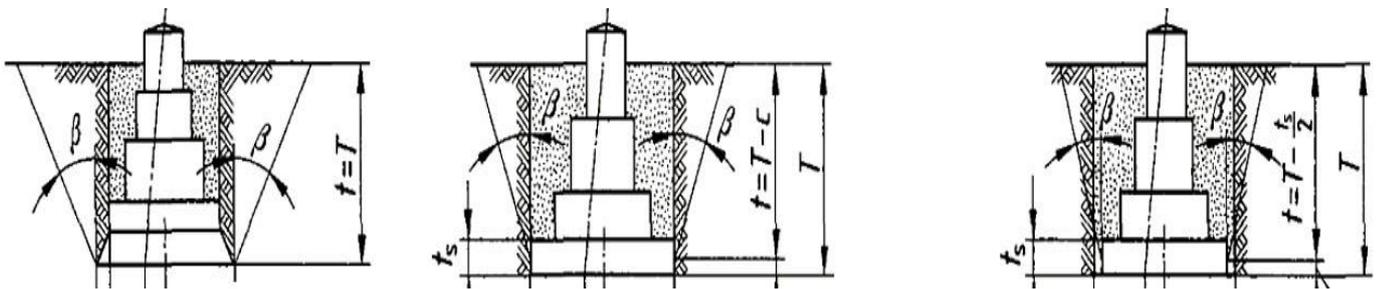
Fondation à redans, fondation bétonnée contre paroi, fondation à coffrage
